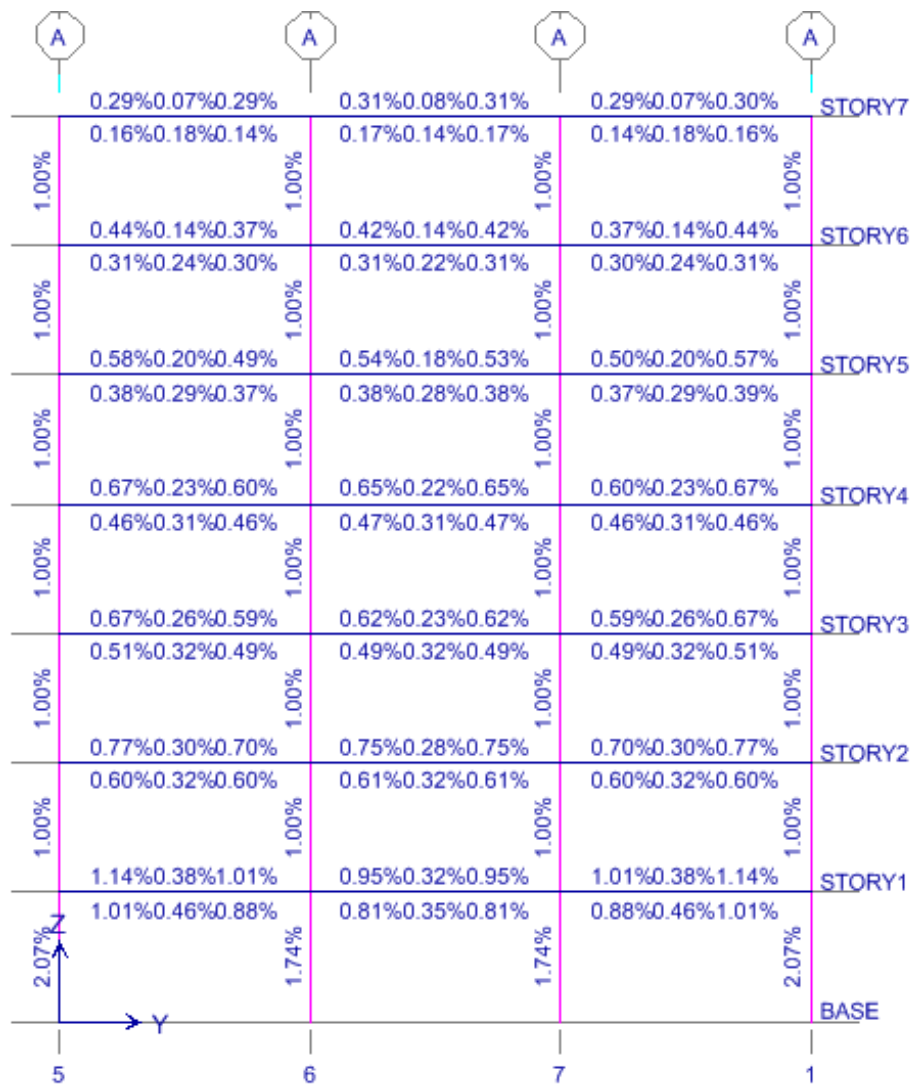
Detalle de la cuantía de refuerzo para el pórtico A del edificio.
